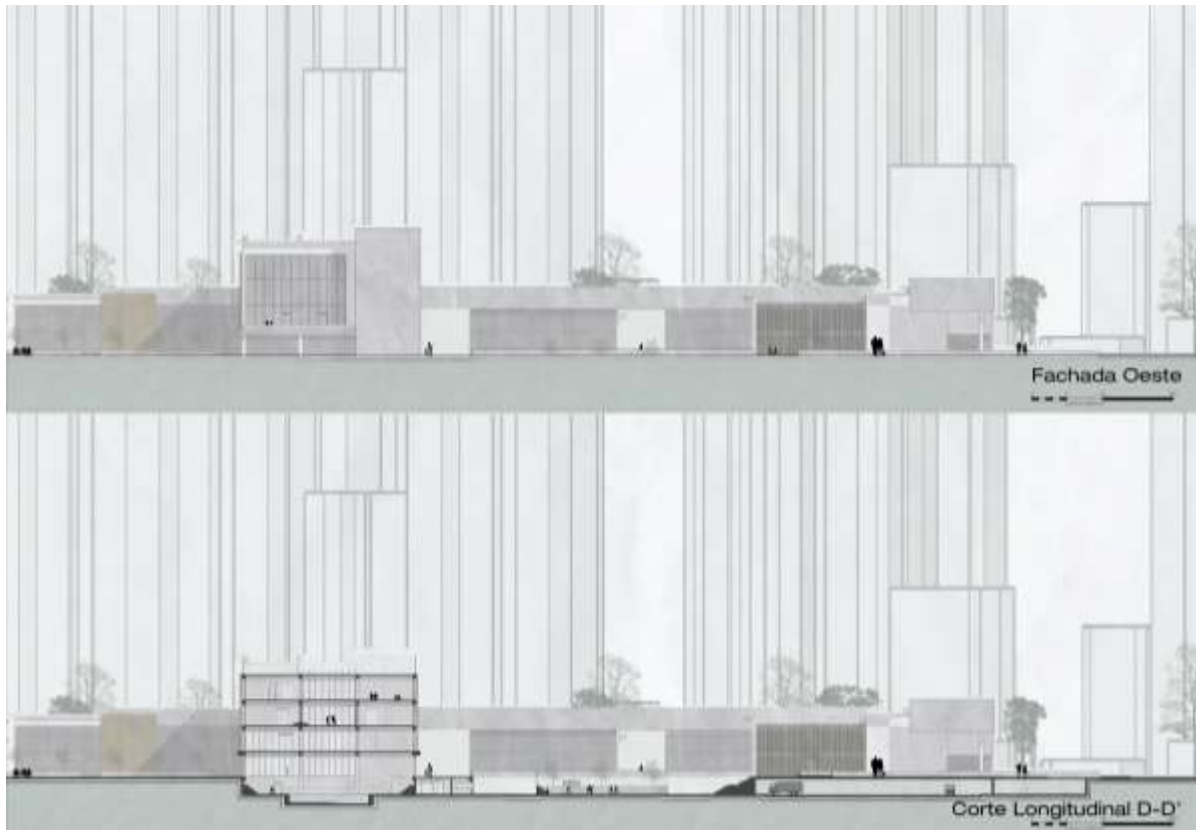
Fachada Oeste-Corte D. Elaboración propia
